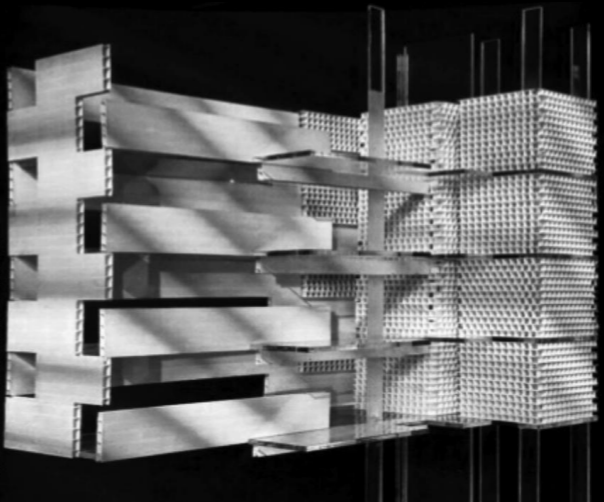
Fuente: Skylar Morán SECCIÓN DE MAQUETA SISTEMA ESTRUCTURAL
